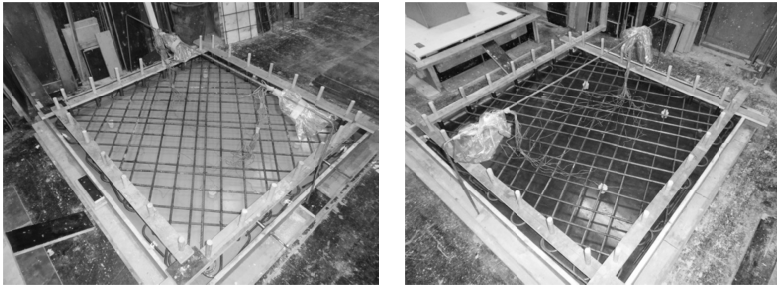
Bewehrung Großversuche vor dem Betonieren: (a) Schweiß-Stumpfstoß der Bewehrung und (b) Bewehrung Z1 mit $\Theta = 0^\circ$
